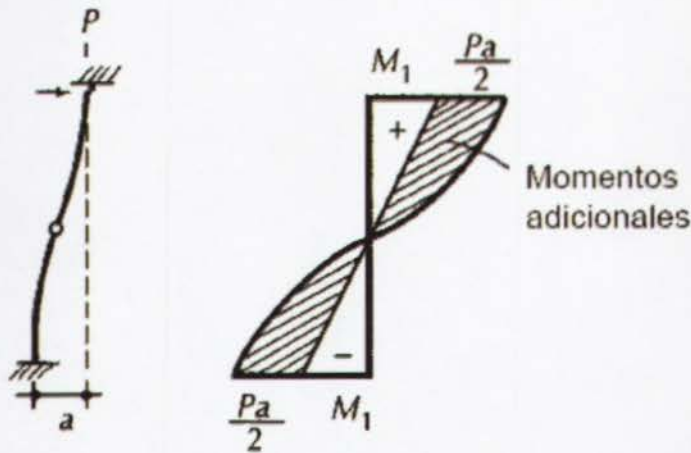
Desplazamiento lateral en la cabeza del pilote.
